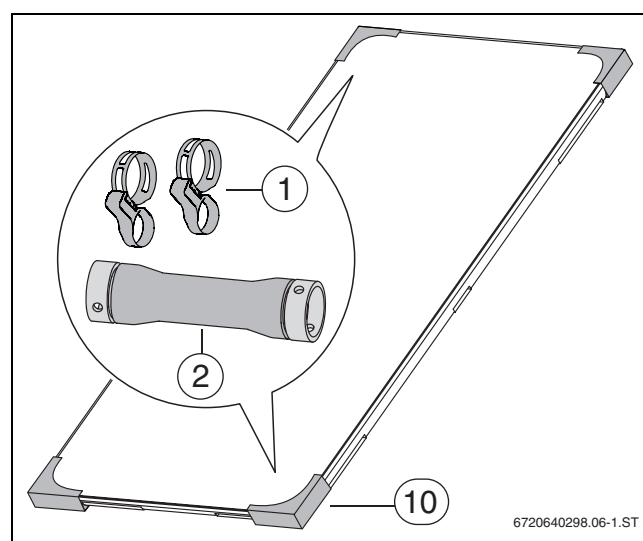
2 angolari di protezione per il trasporto contenenti ognuno 1 set di collegamento (1 set di collegamento contiene 2 fascette stringitubo e 1 tubo di gomma per solare)
